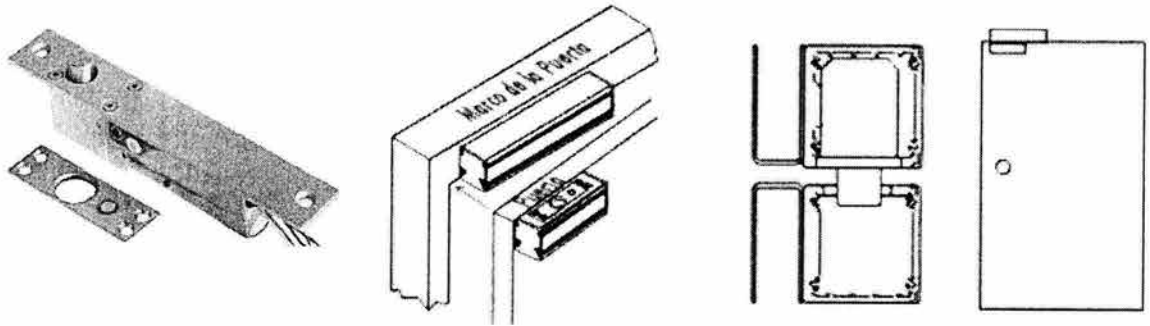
Cerradura eléctrica, su instalación y operación en una puerta de acceso.
